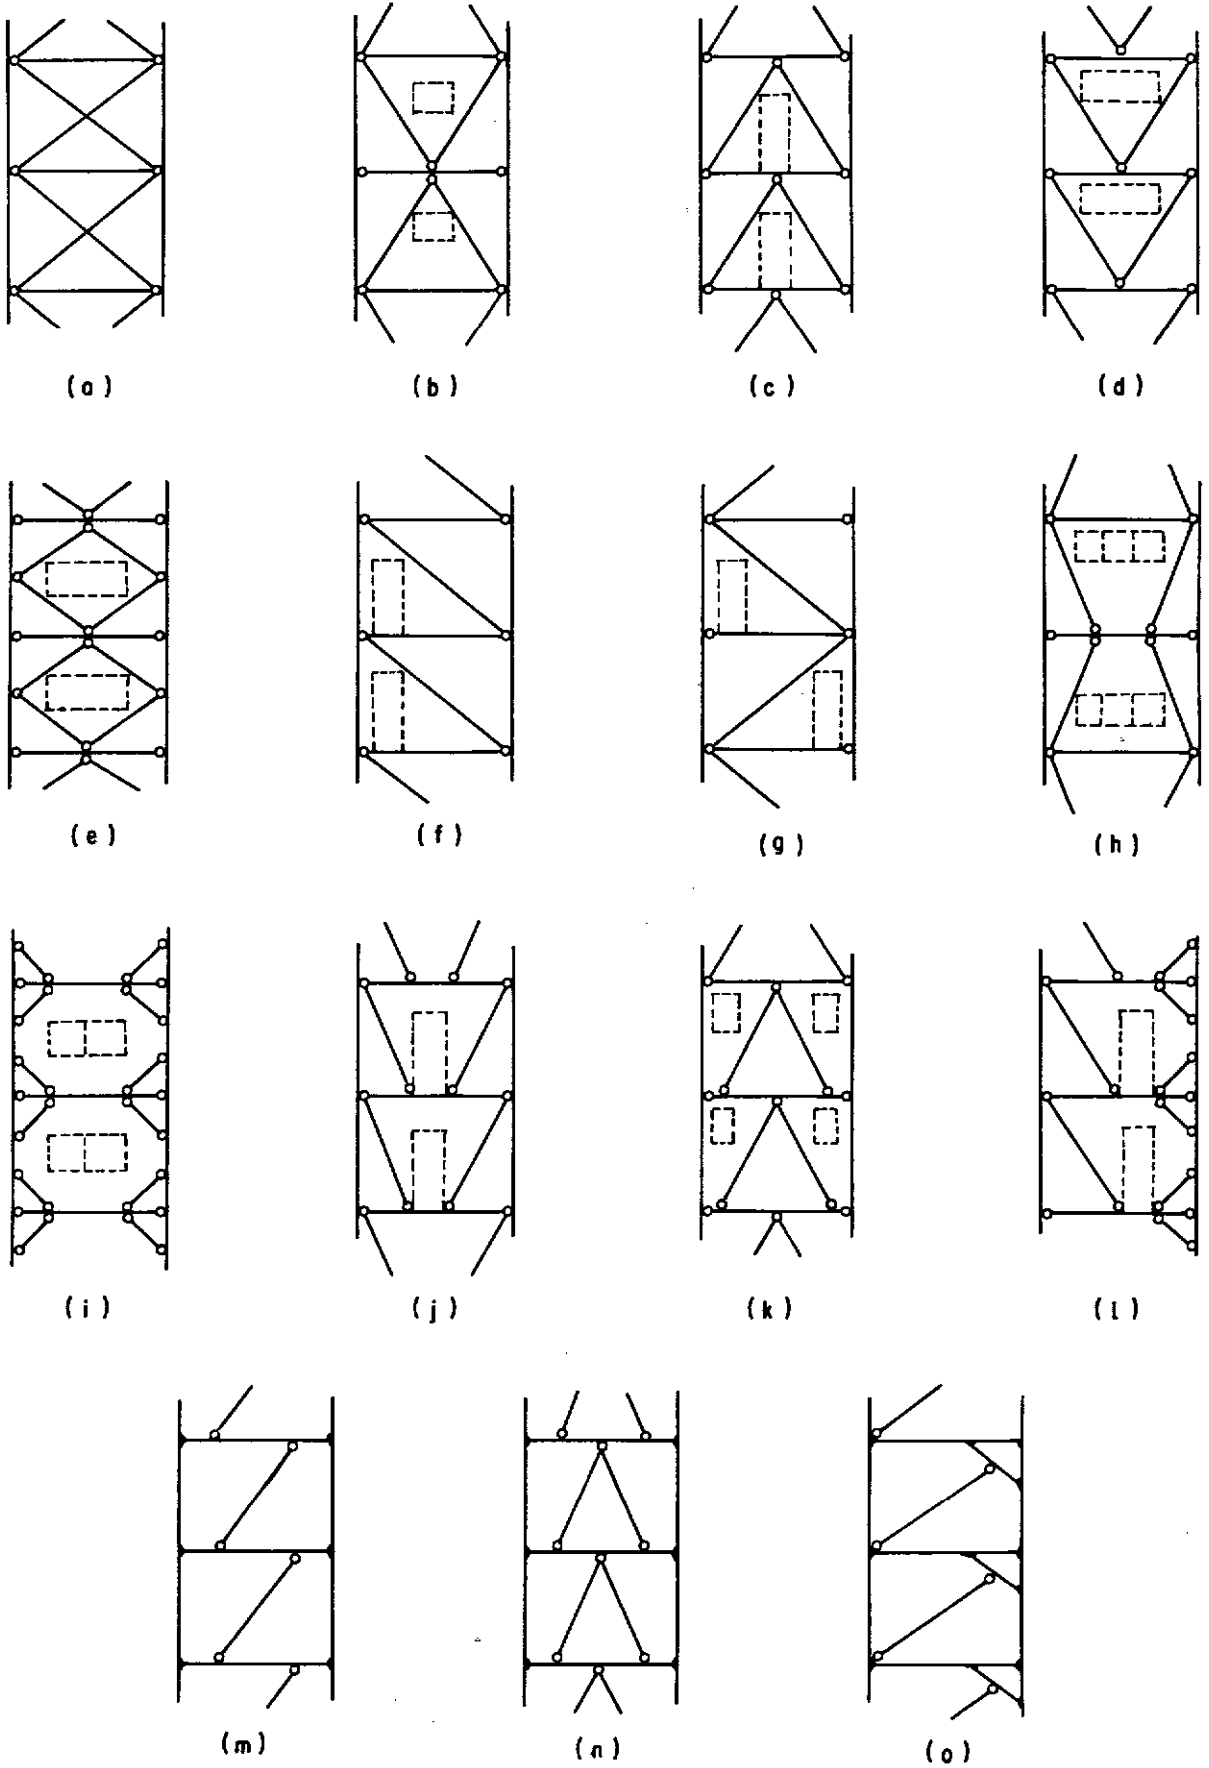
TIPOS DE CONTRAVENTAMENTOS EM TRELIÇA.
